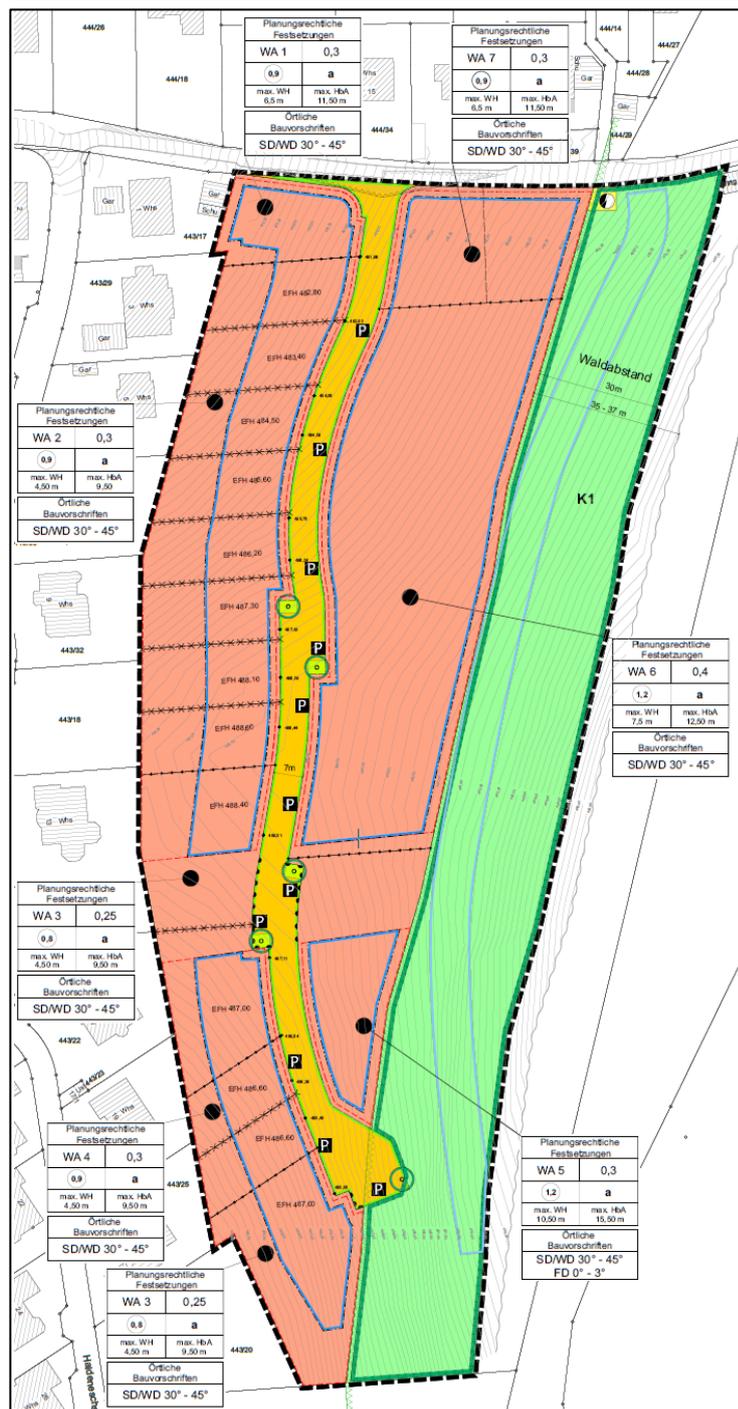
Bebauungsplan „Hüttenberger Weg“, Stadt Ravensburg, (Stand 30.04.2021)
